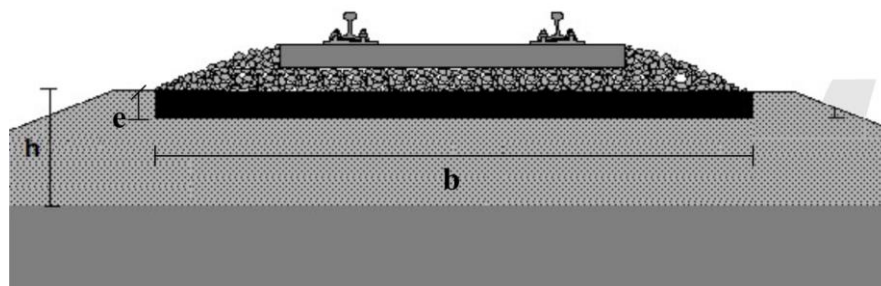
Módulo tipo losa bajo capa de subbalasto de vía única.
